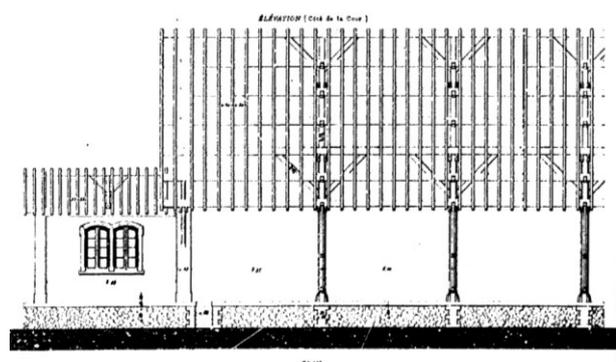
Sezione della Halle Marchandise de la Gare de St. Amand. Fonte: blog di collezionista privato, Jean-Claude Drion
